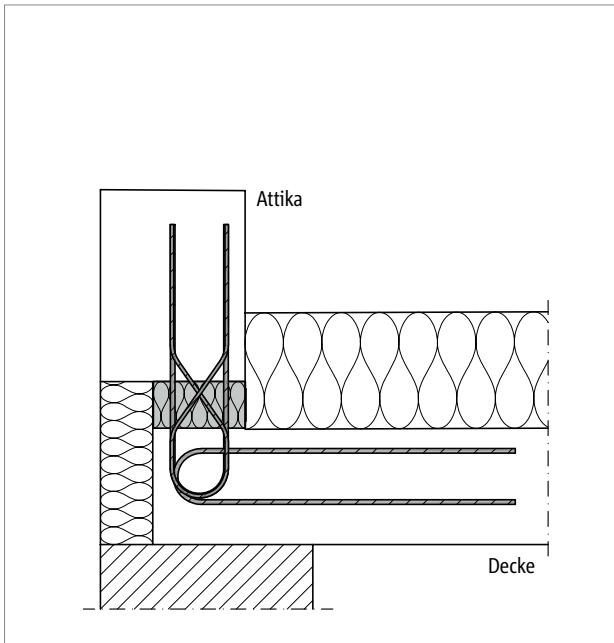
Schöck Isokorb® T Typ A: Anschluss einer Attika (T Typ A-MM1)
